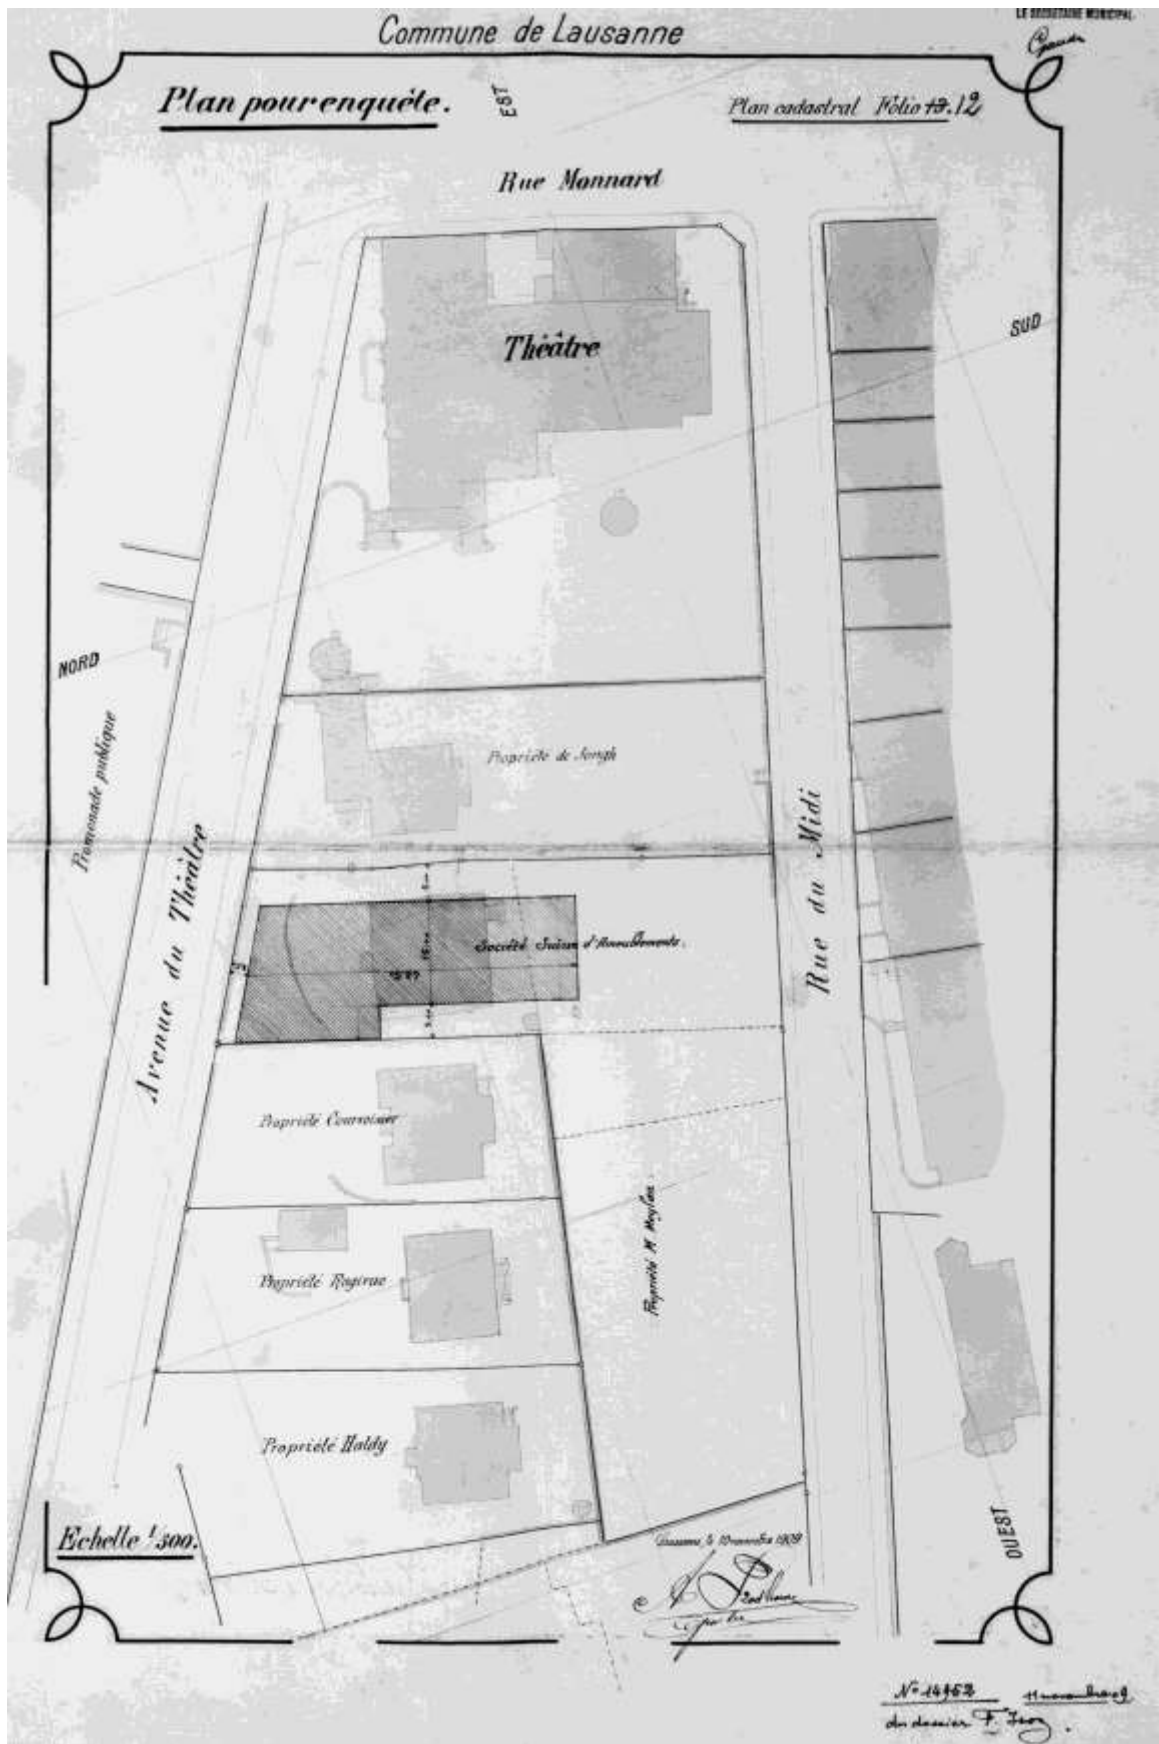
Plan de situation entre l'avenue du Théâtre et la rue du Midi, 10.11.1909 (AVL).
